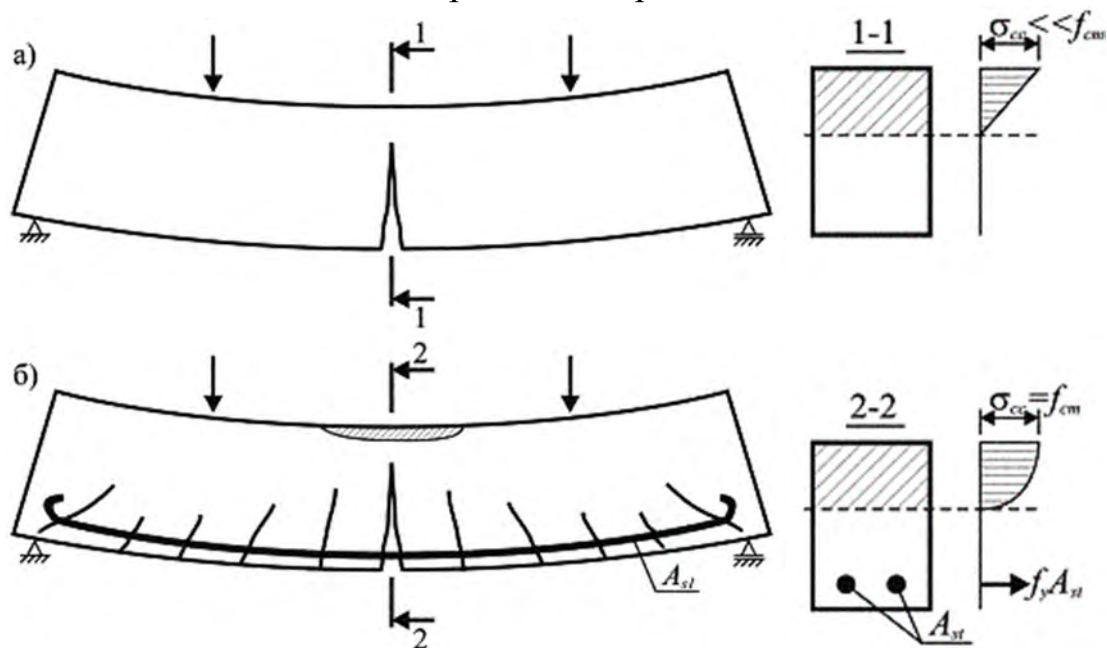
Характер образования трещин и разрушения бетонной (а) и железобетонной (б) балок
